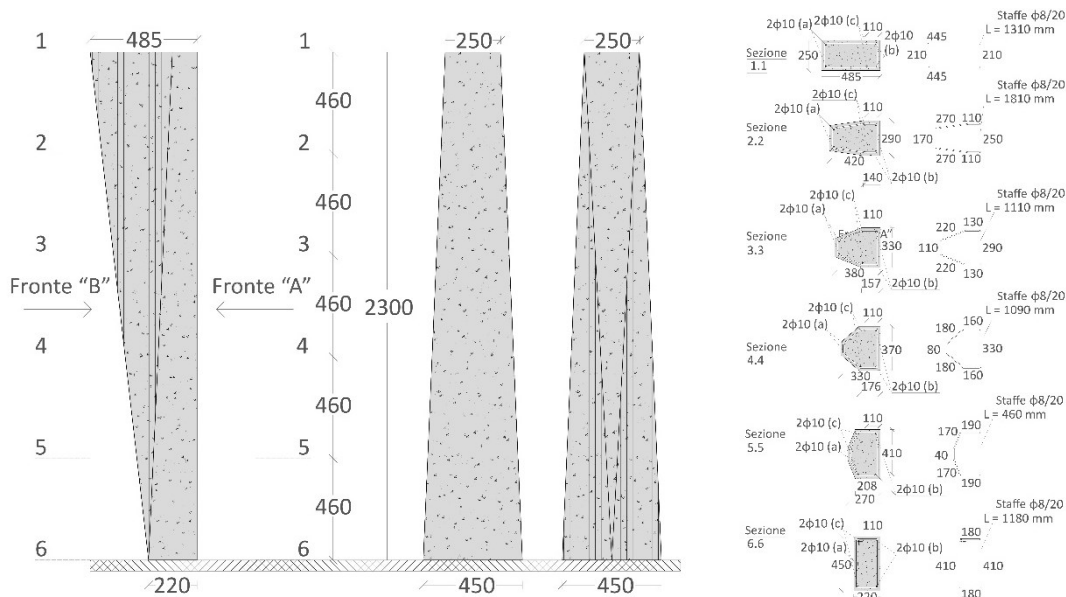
Prospetti e sezioni dei due pilastri a sezione variabile collocati lateralmente
